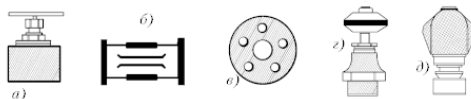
Вентили и прокладки различной конструкции: а) запорный муфтовый вентиль из ковкого чугуна с крышкой на резьбе; б) муфта соединительная с резьбой внутри; в) фланец металлический; г) открытая ГВО; д) закрытая ГВЗ
